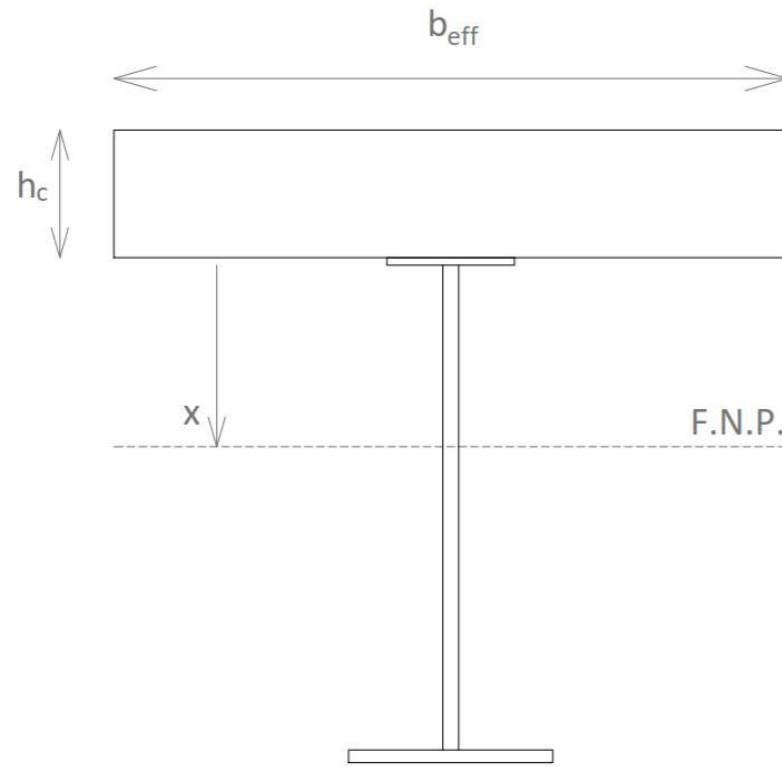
Fibra neutra plástica en el alma de la viga transversal (fuente: elaboración propia)
